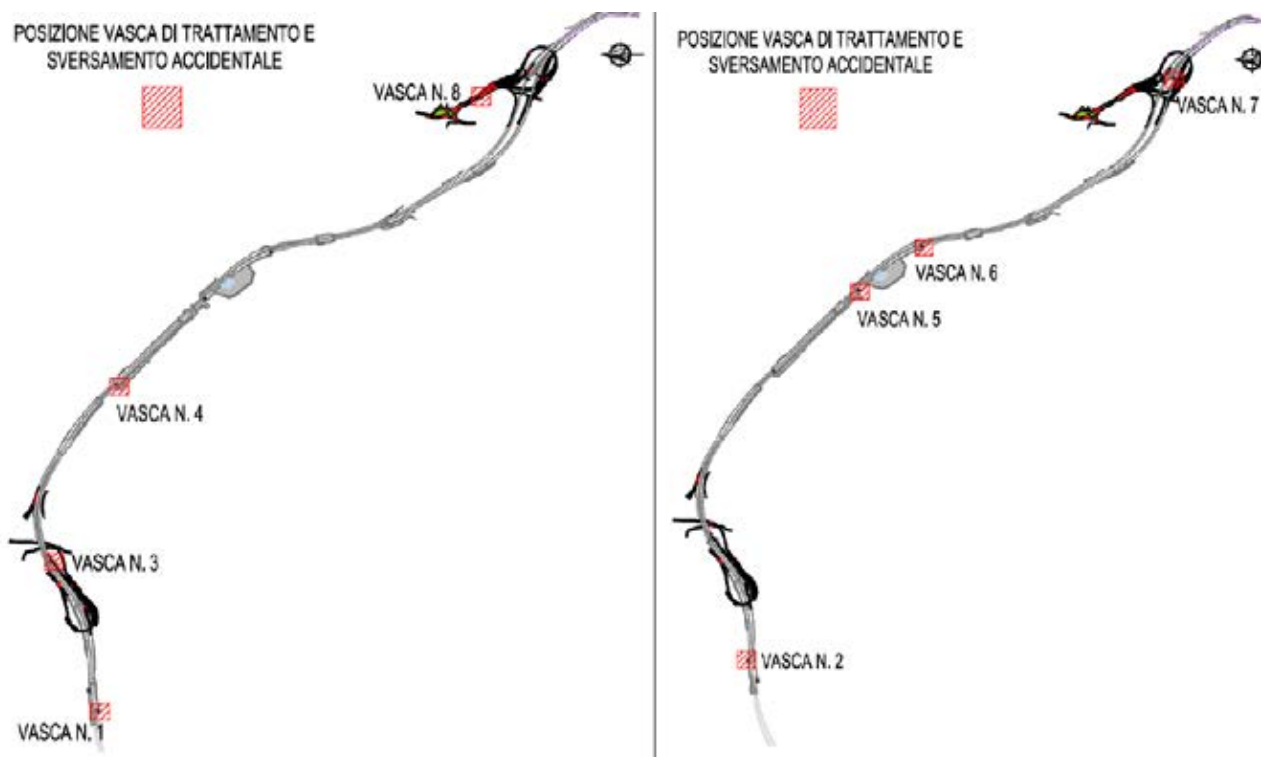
Stralci planimetrici del tracciato stradale con l'ubicazione delle due tipologie di vasche previste.
